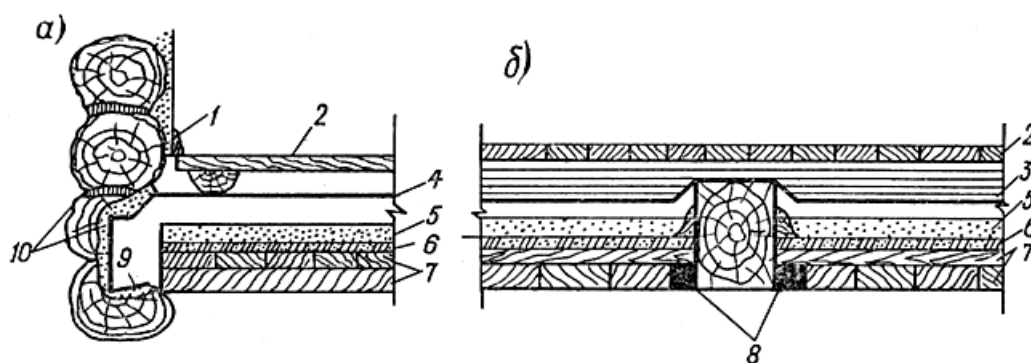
Детали междуэтажного перекрытия со щитовым накатом
